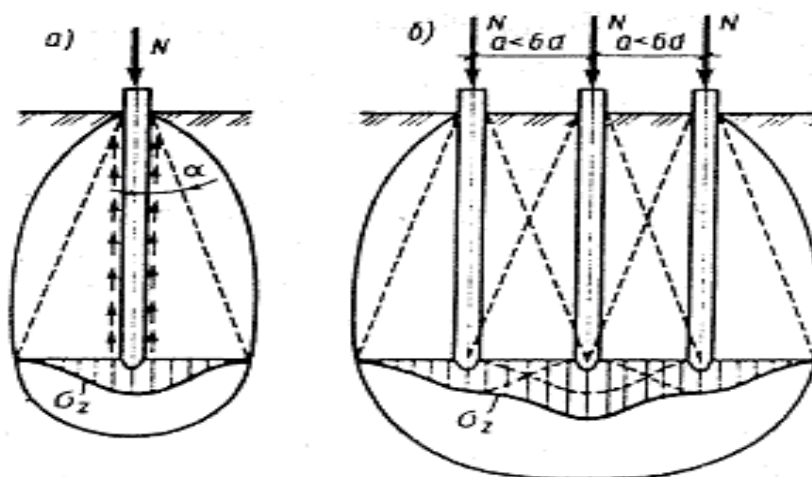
Схеми передачі навантаження на ґрунт основи:
